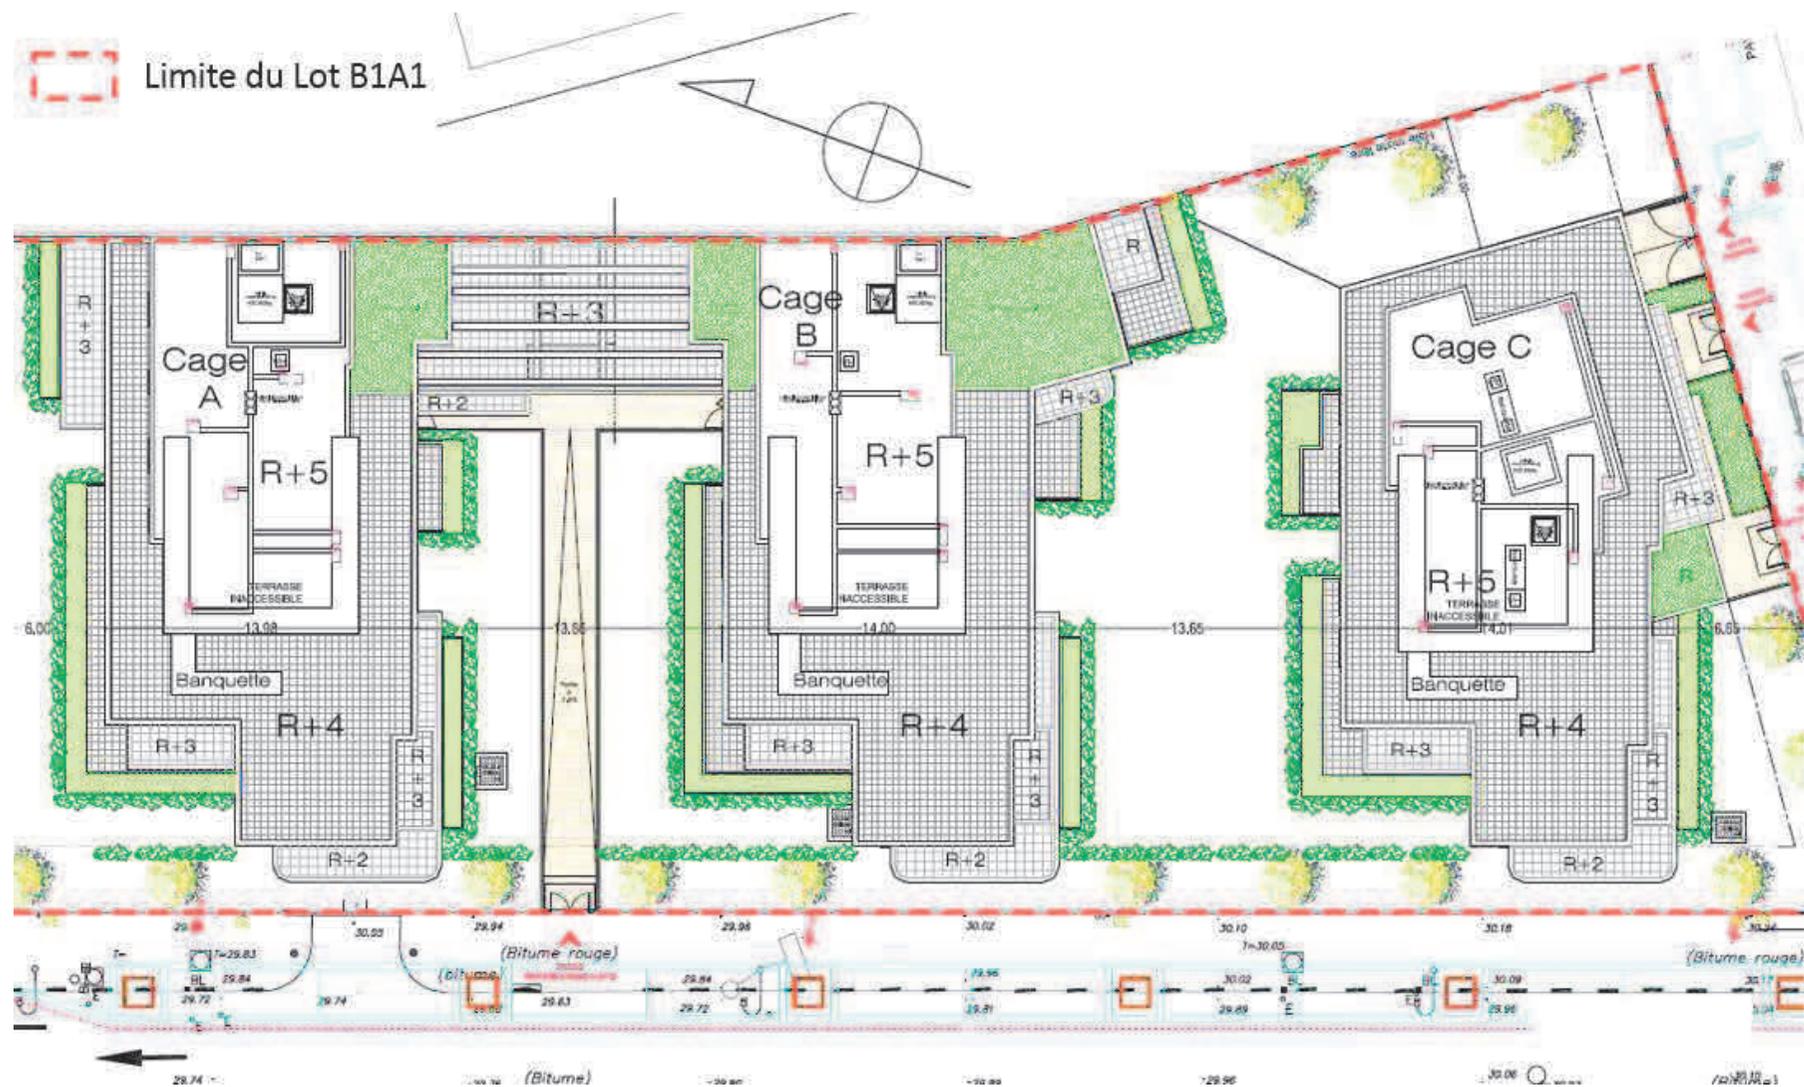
Plan masse du Lot B1A1 (Source : International d'Architecture)
